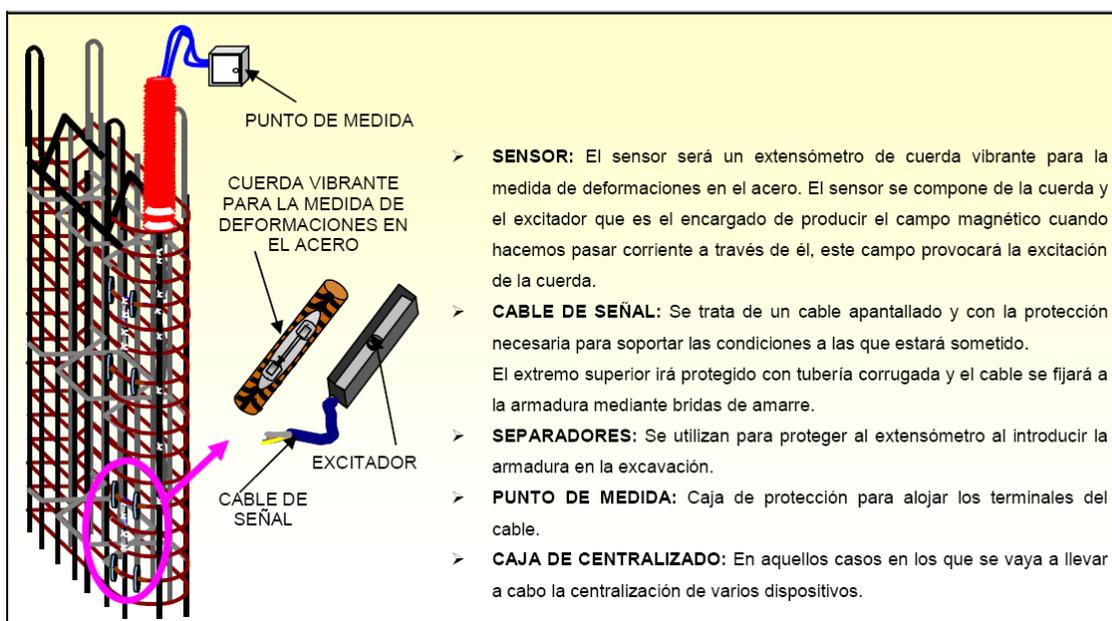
Esquema de instalación armadura de pantalla de hormigón con extensómetro de cuerda vibrante (Consocio Línea 1, 2017)
